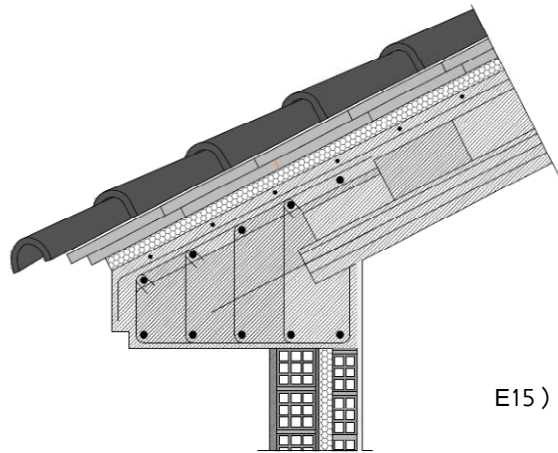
Sección constructiva. Zona este. Estado rehabilitado.
